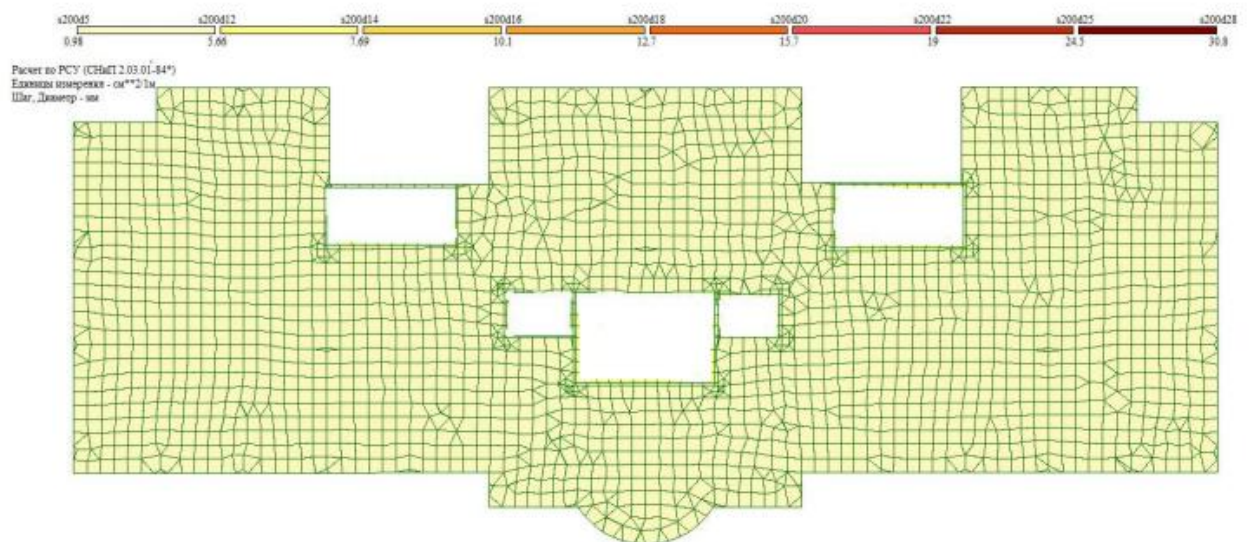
Армування плити за напрямком X. Верхня арматура
